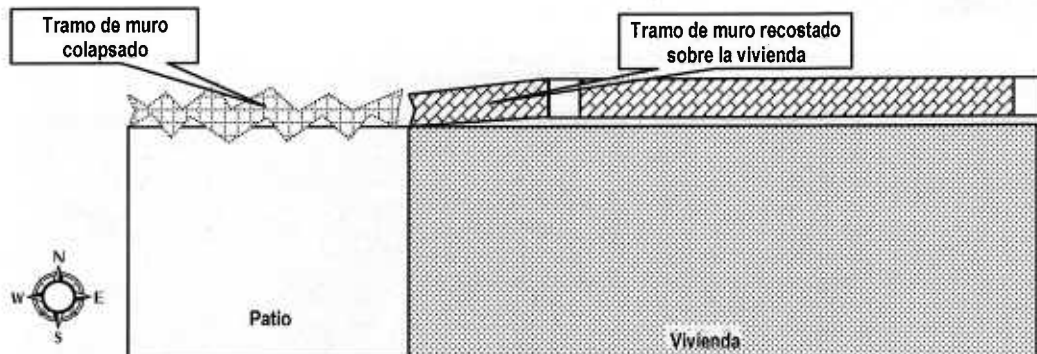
Disposición en planta de la vivienda ubicada en el Lote 40 de la Manzana 19, con respecto al tramo de muro colapsado
